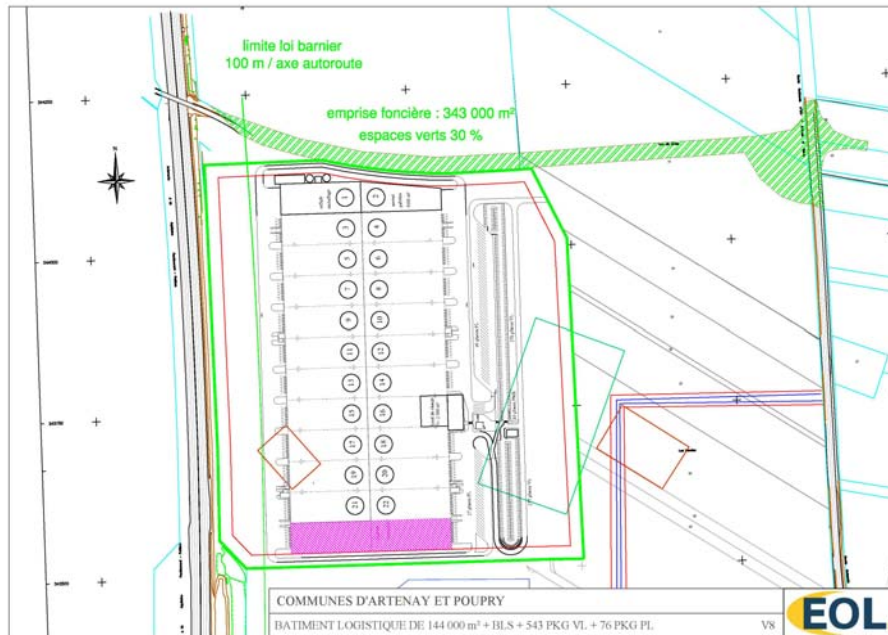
Zoom sur plan projet sur la tranche 2
